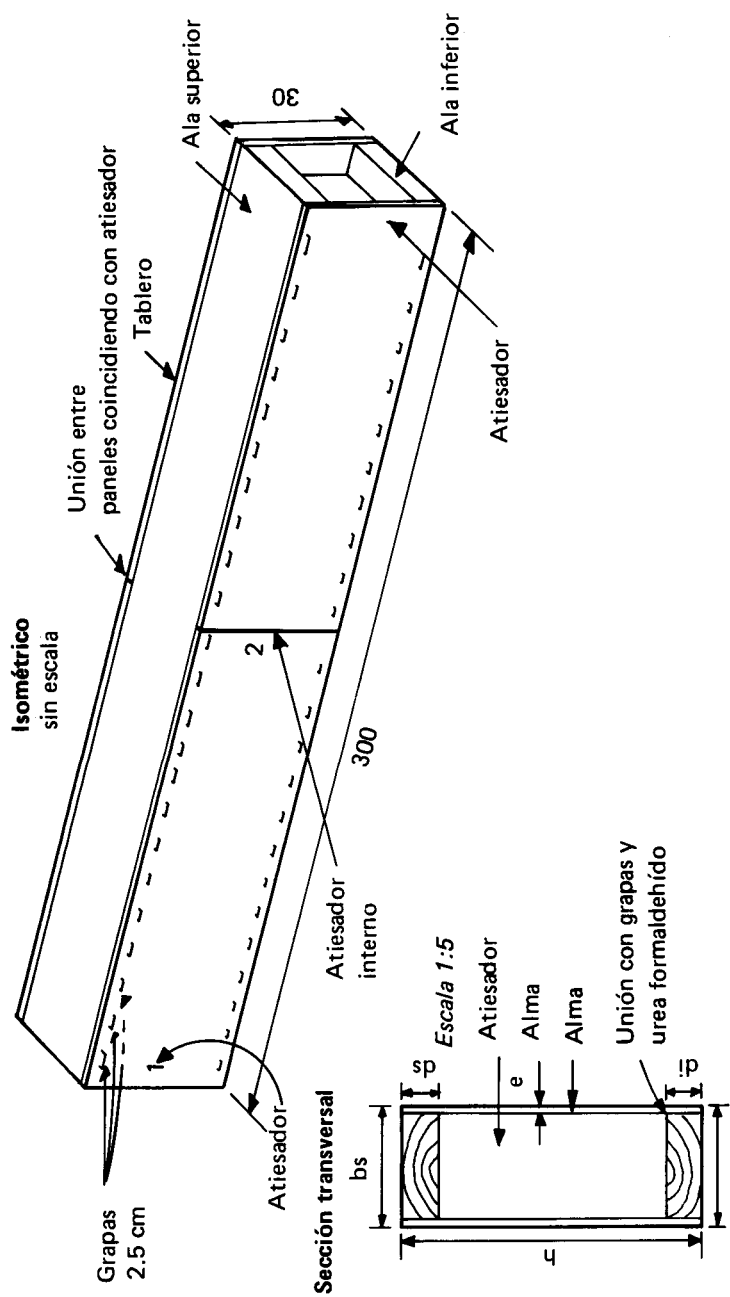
Detalle de las vigas cajón construidas con madera aglomerada y sólida ensarpadas a flexión por Picado F.
